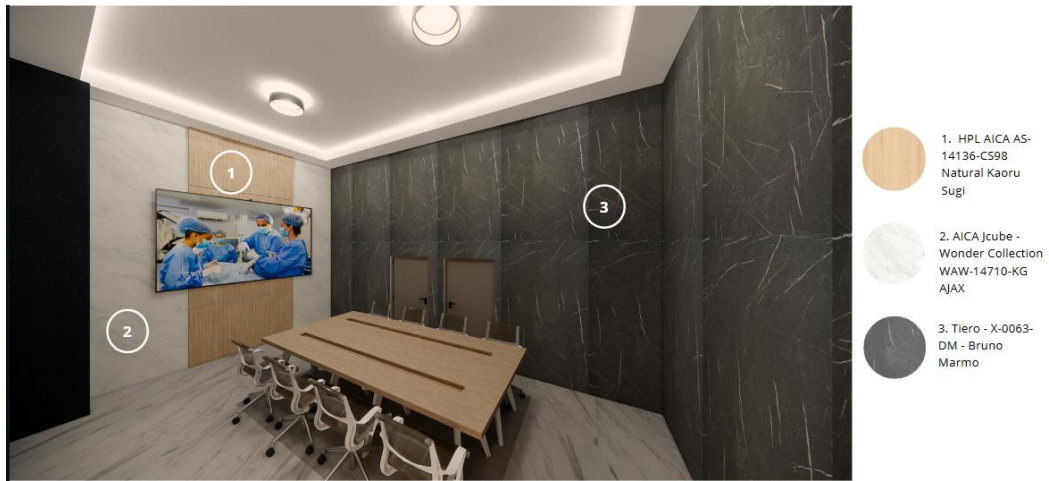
Area dan layout interior ruang kaprodi lantai 2
